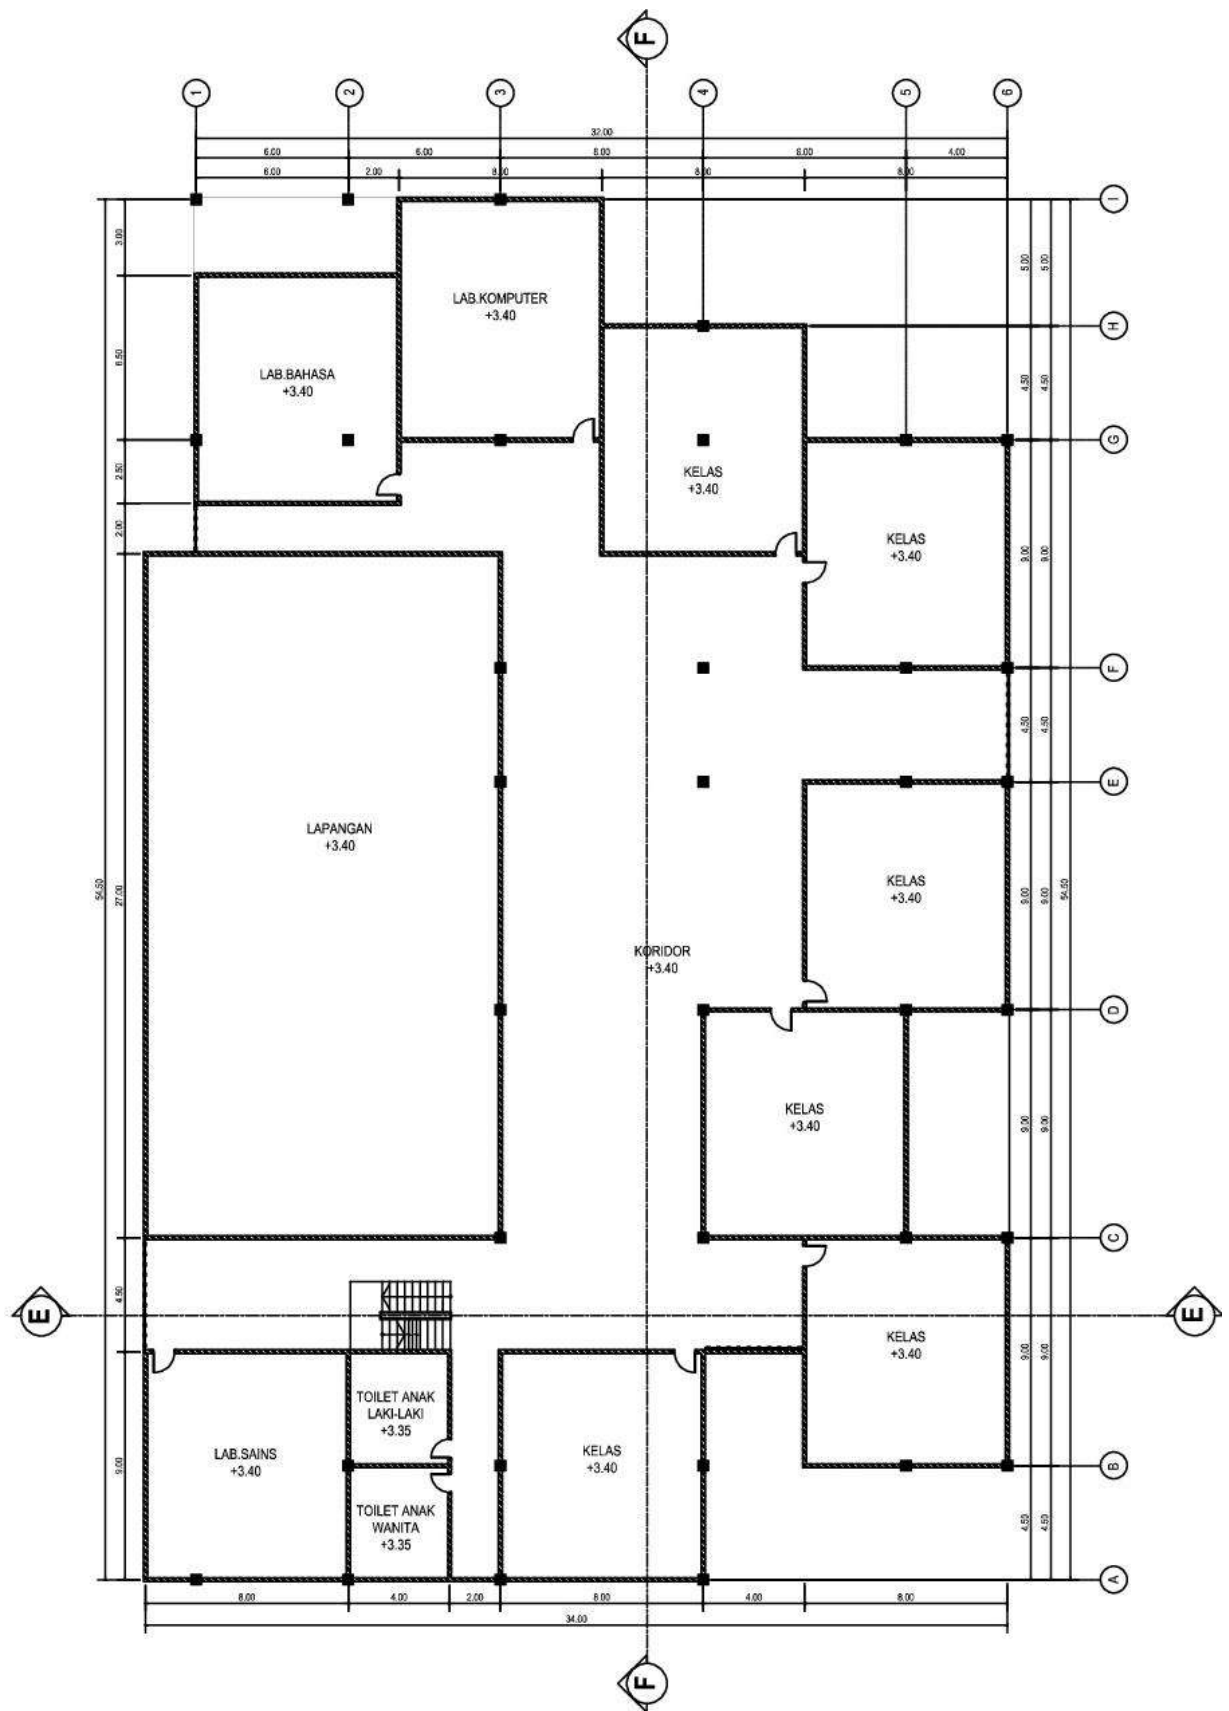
Denah Tempat Penitipan Anak Lantai 1
